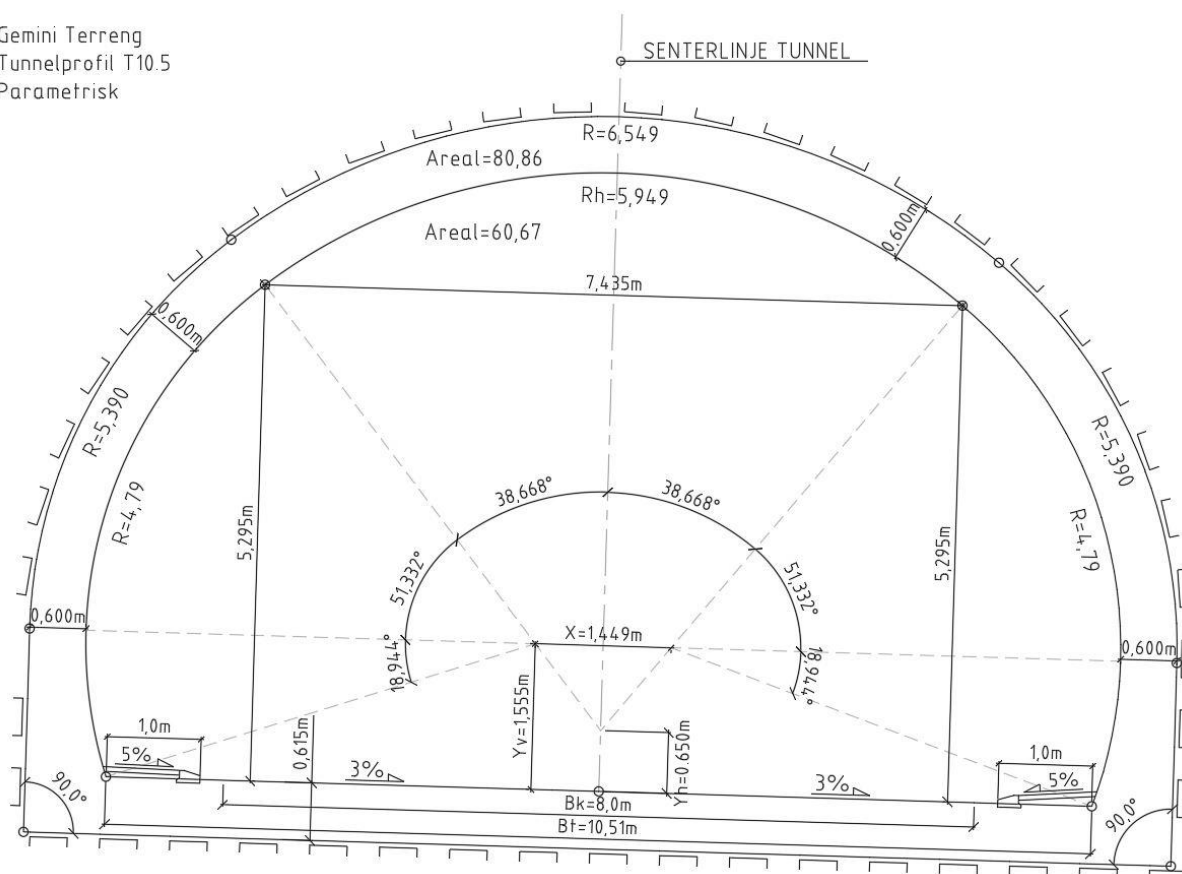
Eksport av parametrisk tunnelprofil T10,5 fra Novapoint Tunnel til AutoCAD og målsatt i AutoCAD.
